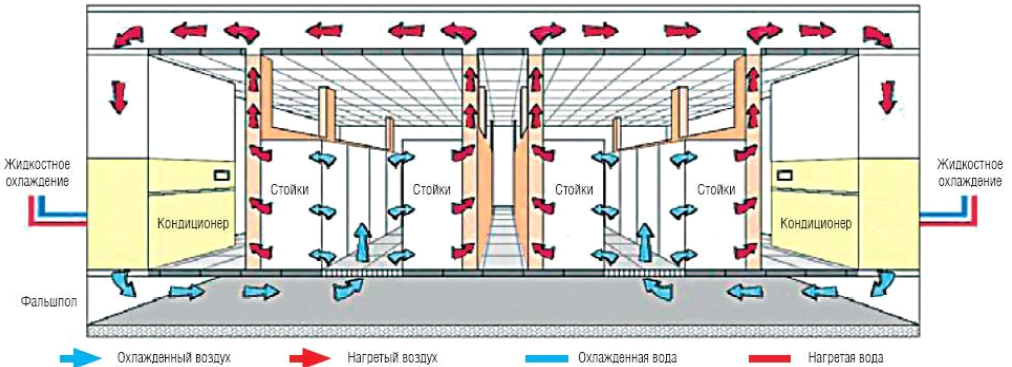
Схема охлаждения на уровне зала и системы вытяжной вентиляции
